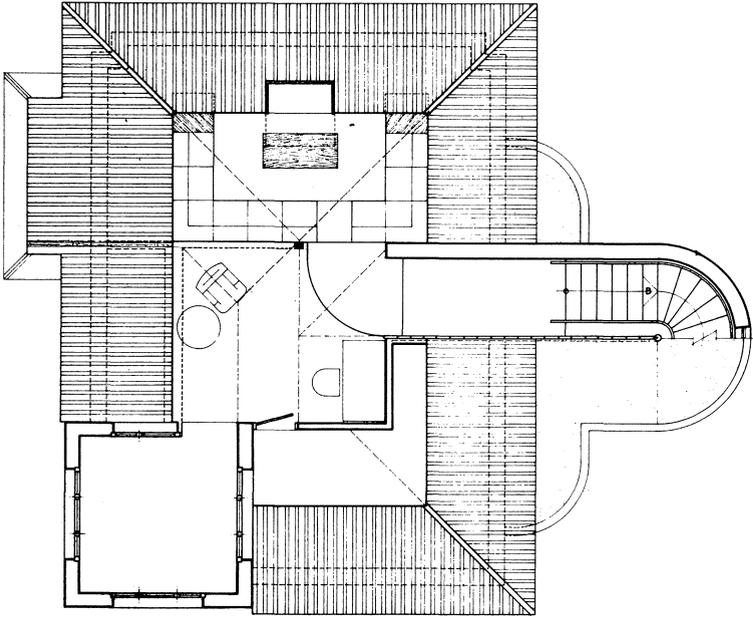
VIVIENDA UNIFAMILIAR EN VIGO - PLANTA ATICO (reformada).
